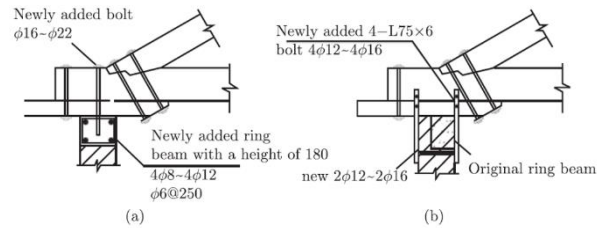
Perkuatan pertemuan pelat lantai kayu dan balok beton dengan kolom (Retrofitting of building structures, Xilin Lu (editor), 2010)
